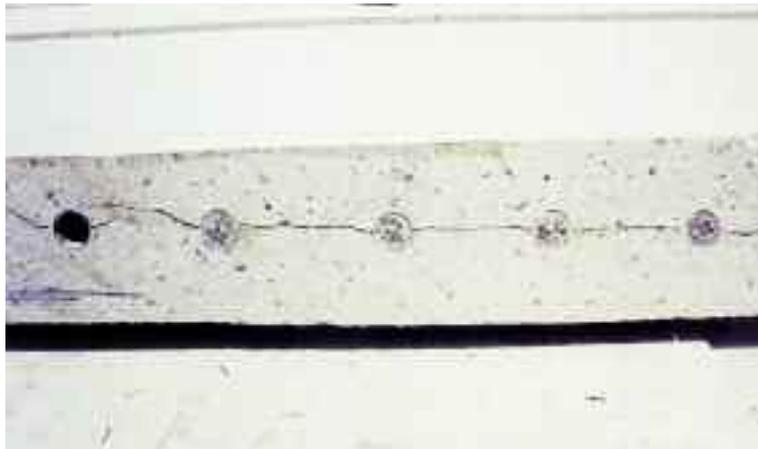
fissure horizontale d'éclatement du hourdis inférieur au pont de Nemours causée par le réancrage des câbles sectionnés (crédit photo DREIF)
